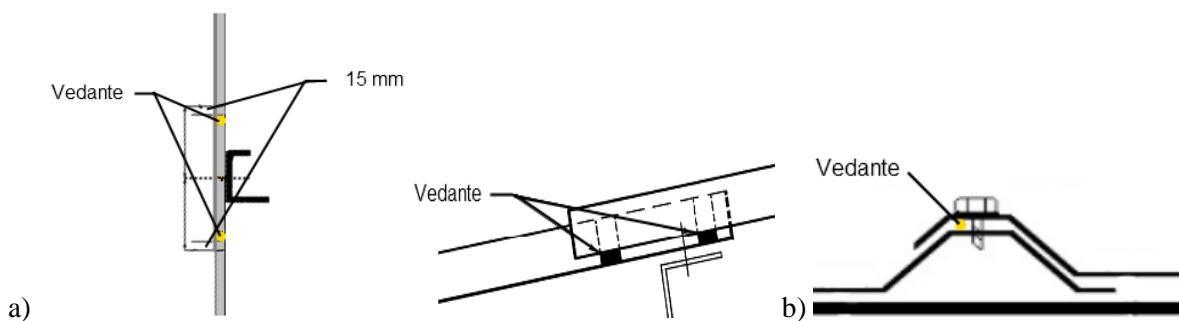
Disposição das tiras vedantes: a) Na junta horizontal, b) Na junta vertical.
